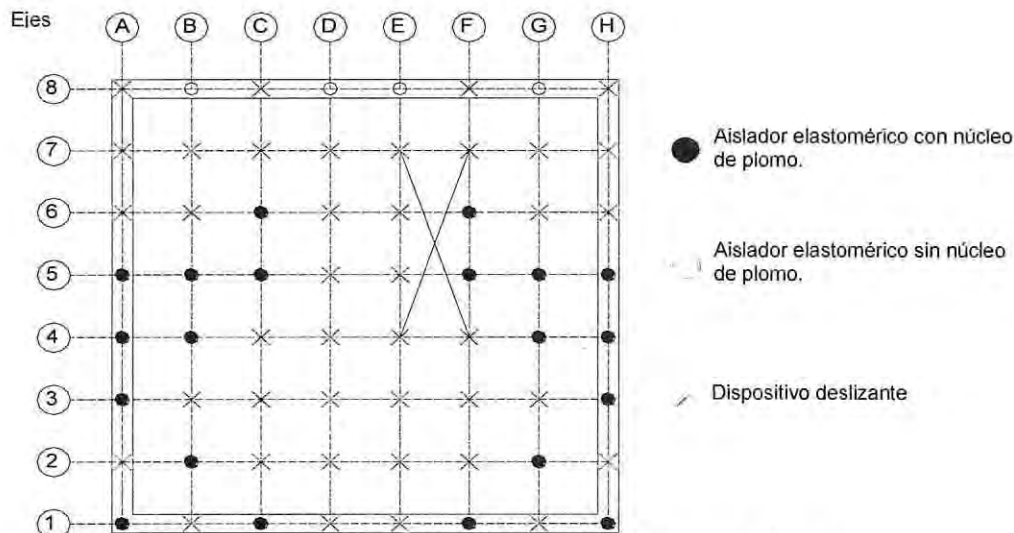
Esquema planta de distribución del sistema de aislación.
